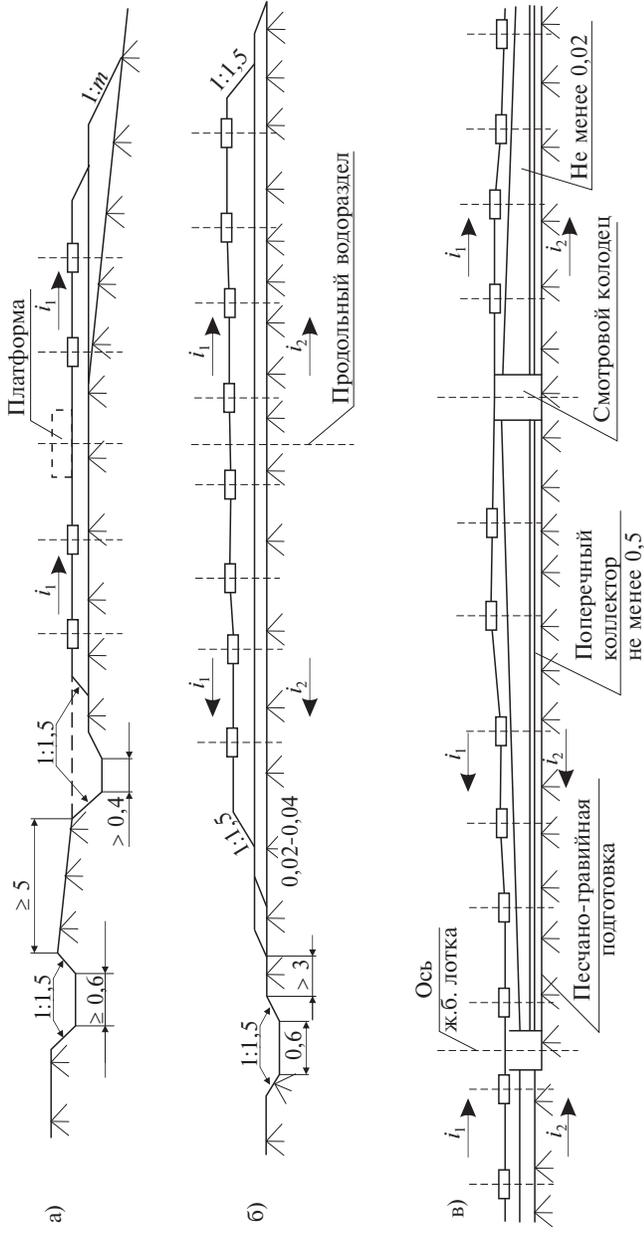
Поперечное сечение основной площадки земляного полотна на отдельных пунктах:
